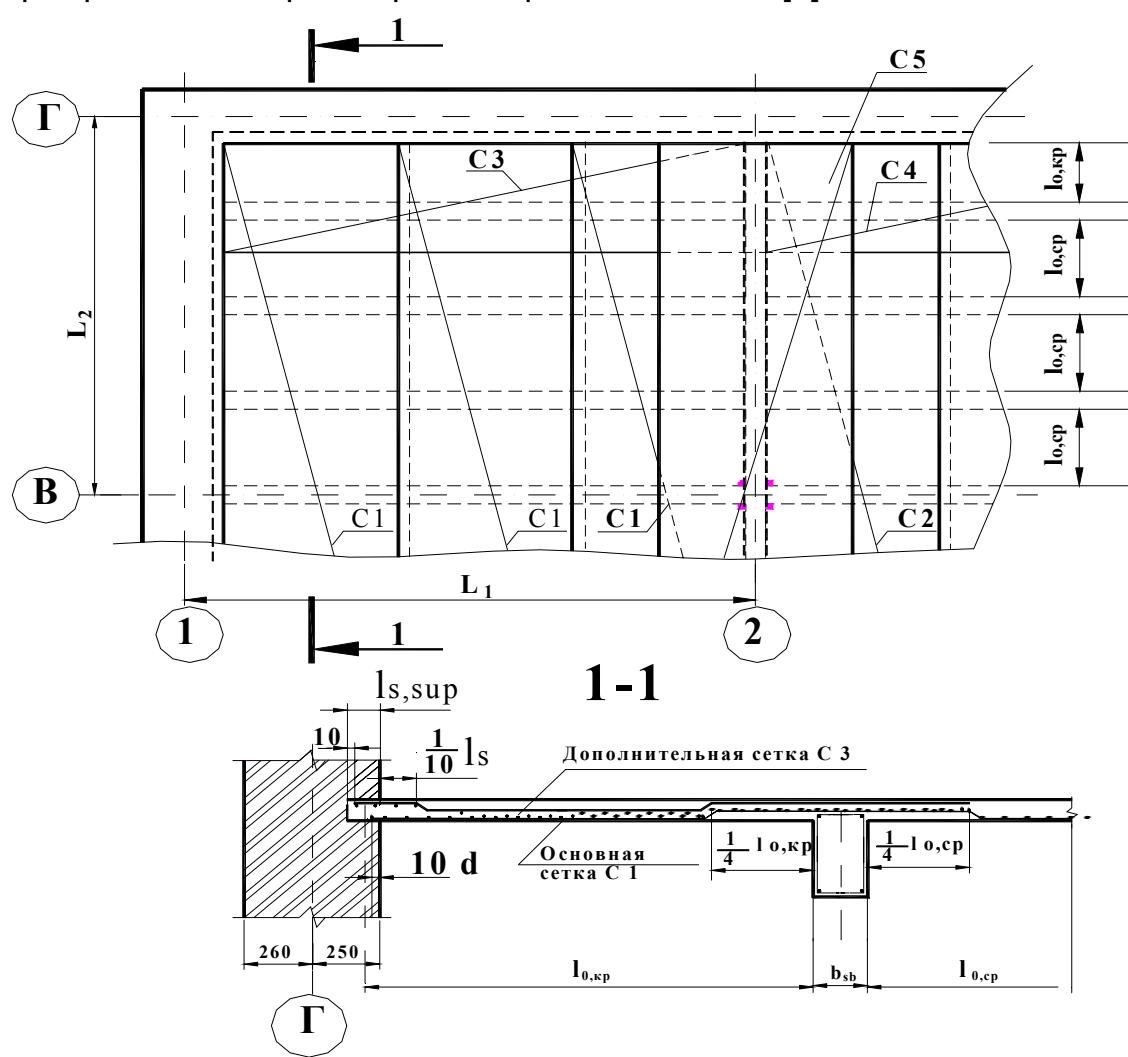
Непрерывное армирование монолитных неразрезных плит сварными рулонными сетками.
